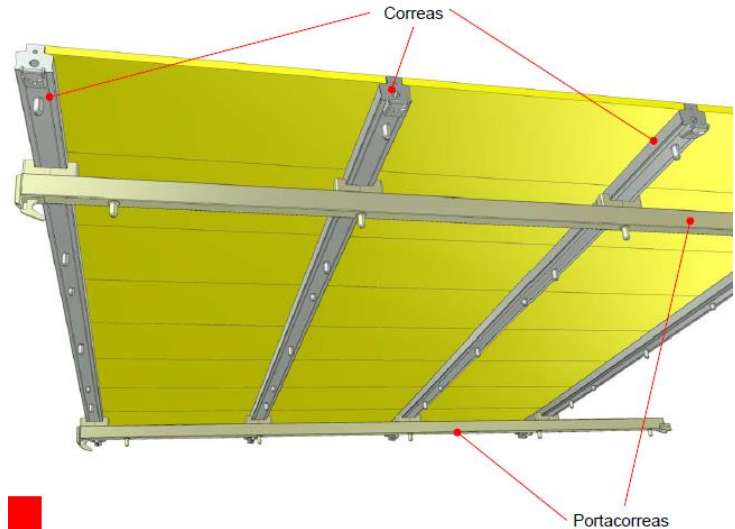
Detalle de los elementos del sistema (STEN, 2013)
